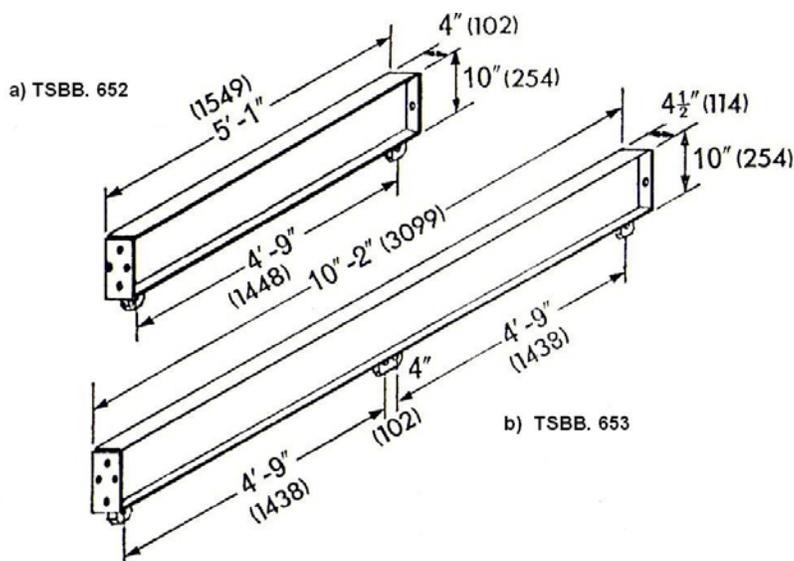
Viga de cumbrera de pilas Bailey (TSBB.652 y TSBB.653).
